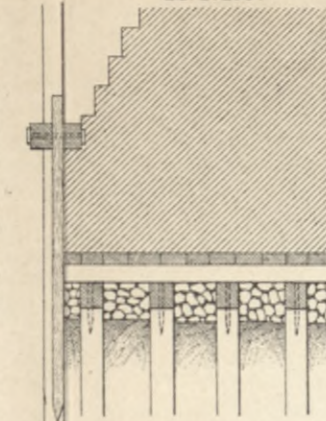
Betonfangdamm als Teil des endgültigen Baues. M. 1:200.
